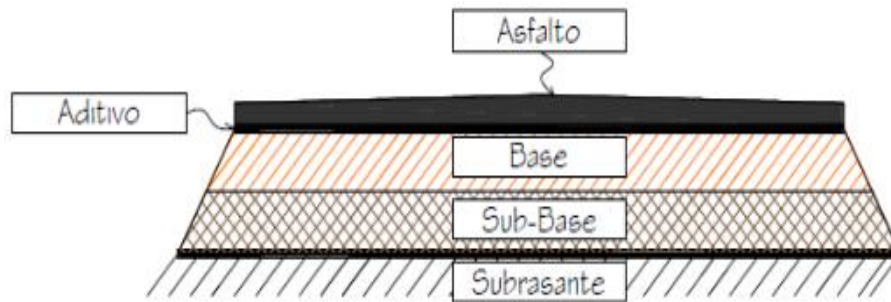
Sección típica transversal pavimento semi-rígido - Fuente: Armijos 2009
